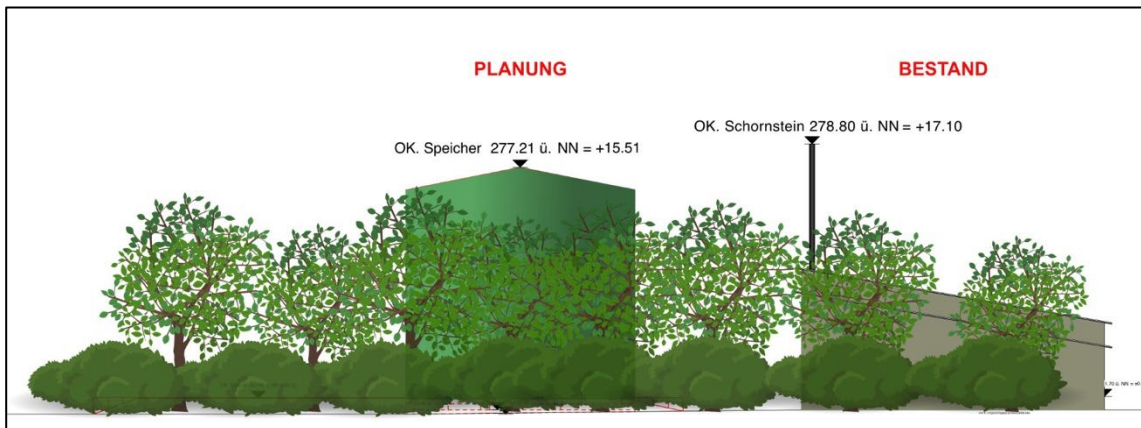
Ansicht – Blockheizkraftwerk und geplanter Speicher mit Eingrünung
